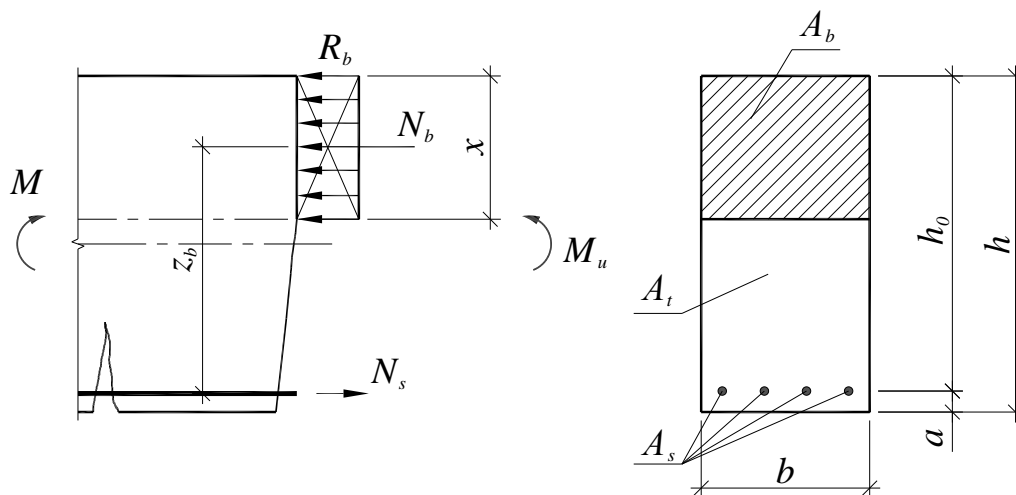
Схема усилий и напряжений в нормальном расчетном сечении элемента прямоугольной формы с одиночной арматурой.
